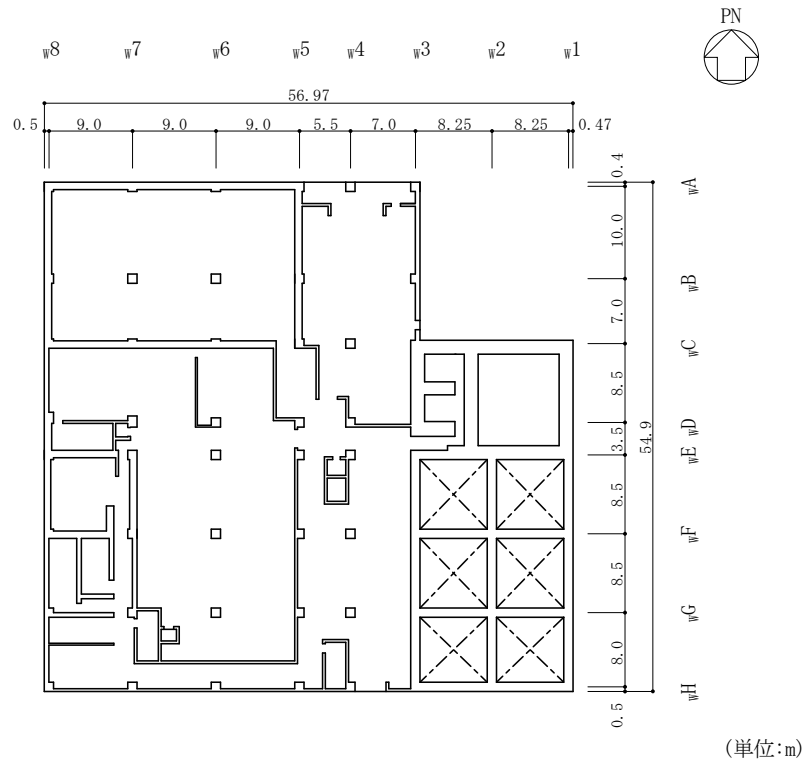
(7) 廃棄物処理建物の概略平面図 (EL 32.0m)
